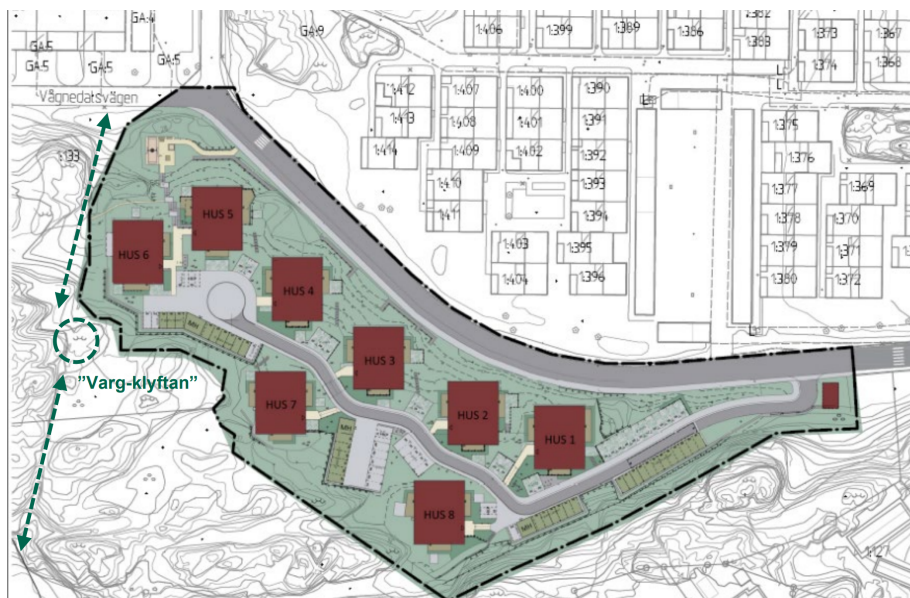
Planområde med de planerade flerbostadshusen. Källa: JM.
